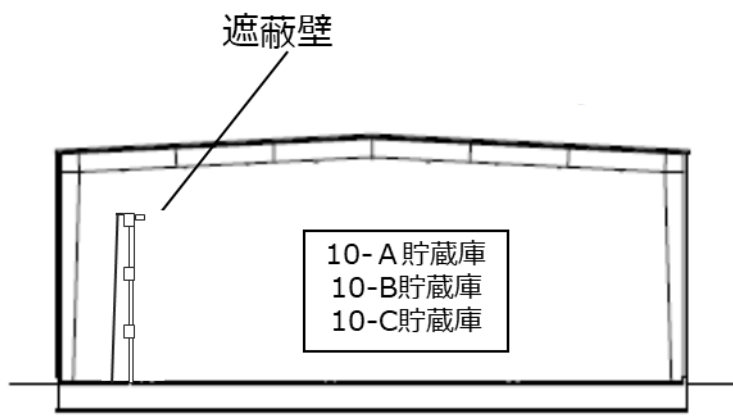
固体廃棄物貯蔵庫第 10 棟の建屋平面図
